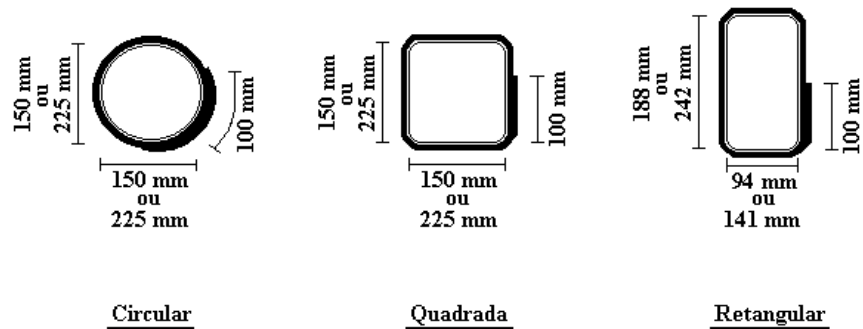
Tipos de Seção e Reforço dos Pilaretes Ensaçados
